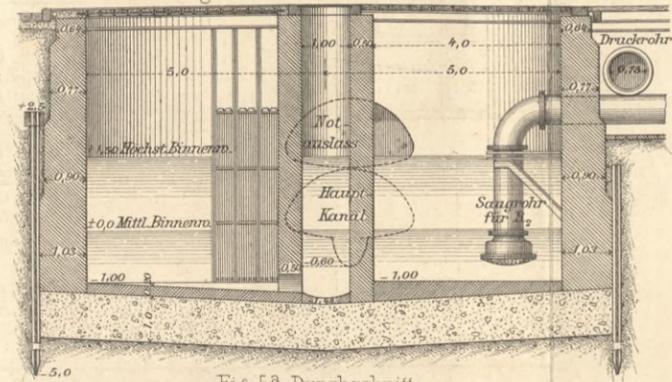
<sup>a-d</sup> Kläranlage bei Wiesbaden.
